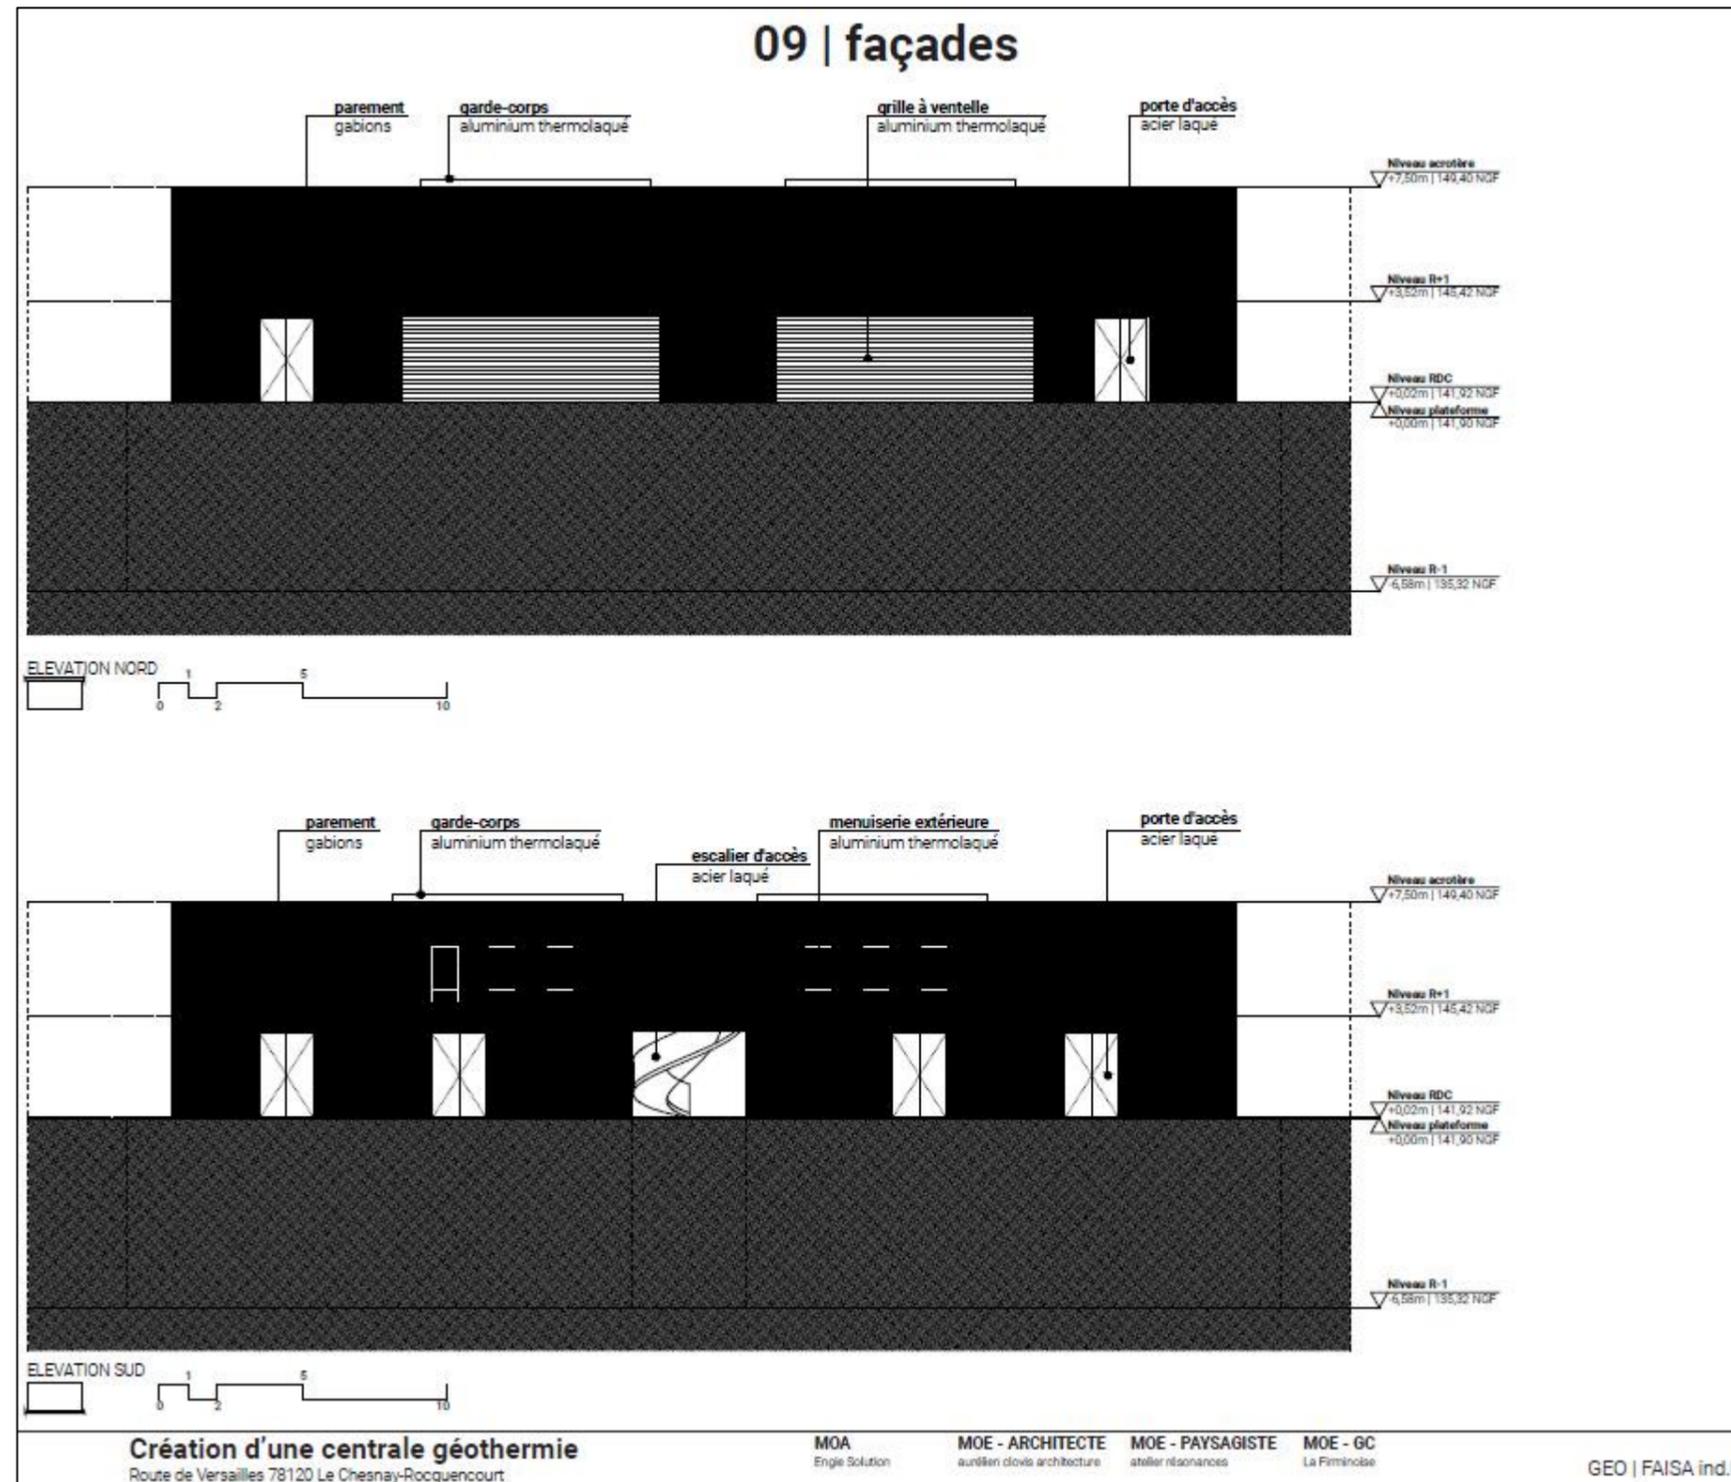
Plan de façades du bâtiment contenant les deux centrales géothermiques – élévations nord et sud (Source : ENGIE Solutions)
